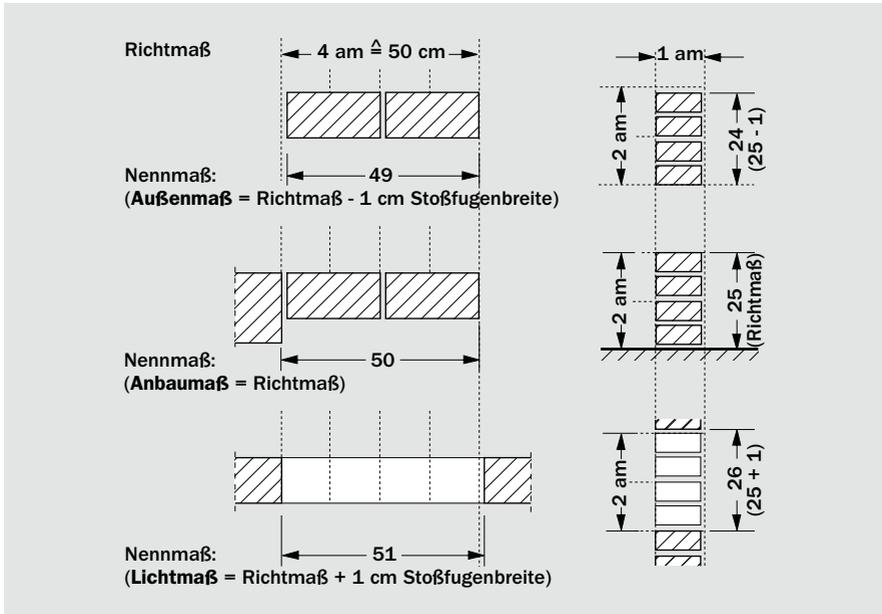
/3: Richtmaße und Nennmaße für Bauweise mit Fuge (Mauerwerk mit Stoßfugenvermörtelung)
